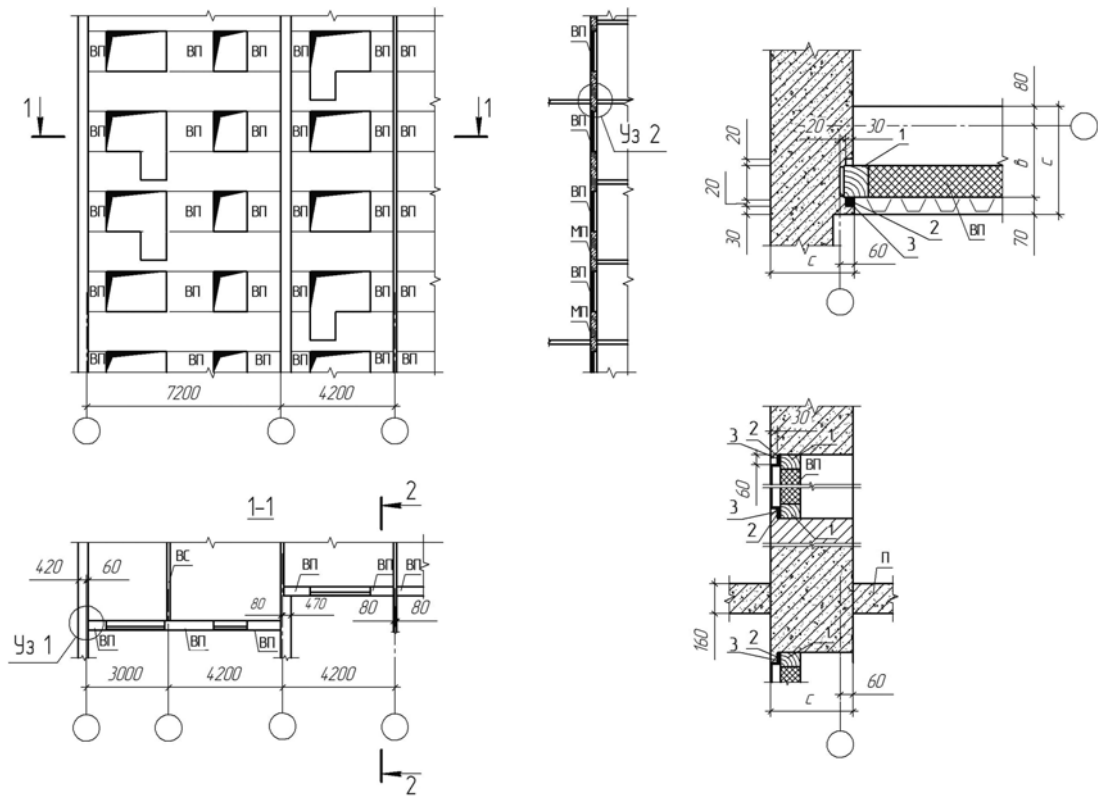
Монолитные наружные стены с небетонными междуоконными вставками:
